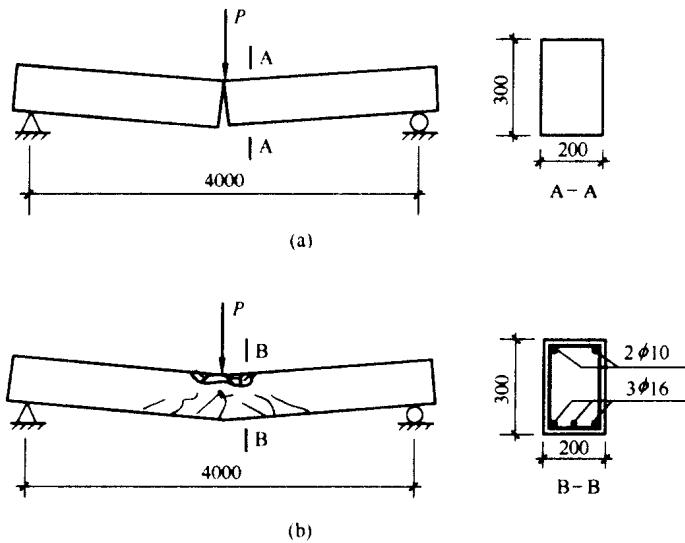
纯混凝土梁与钢筋混凝土梁的破坏情况对比
